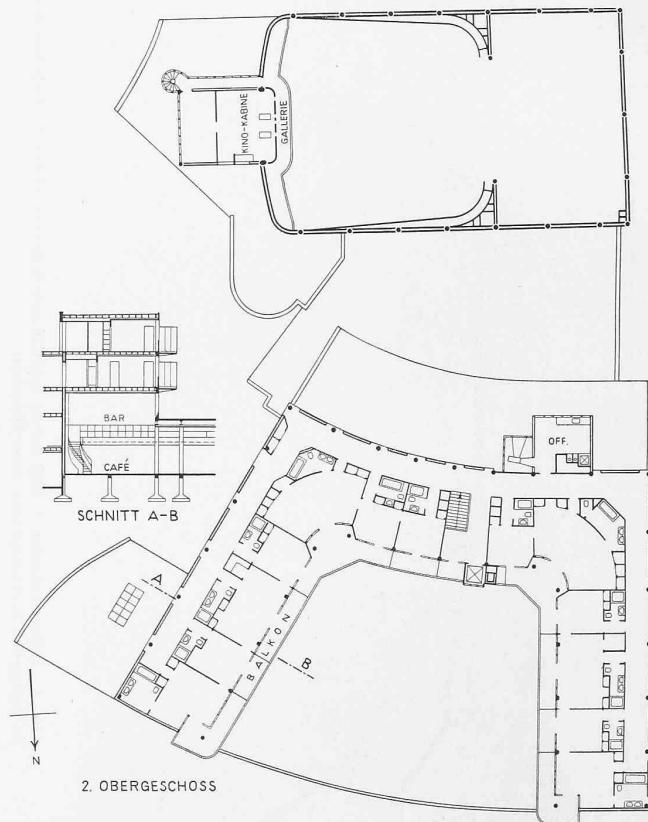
und 2. Grundrisse und Schnitt 1:600 des Grand Hotel Gooi in Hilversum. — Arch. † J. DUIKER.
